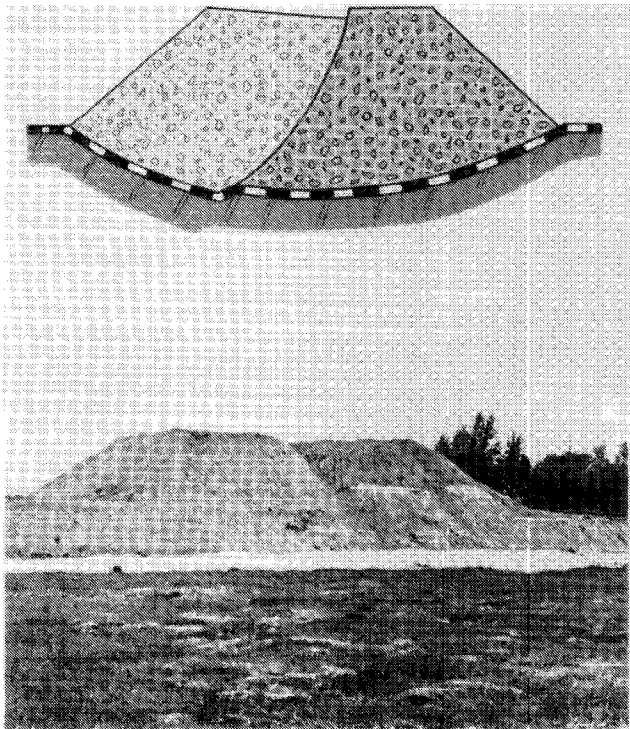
Erdbau (Erddamm mit Armierungsgewebe)
